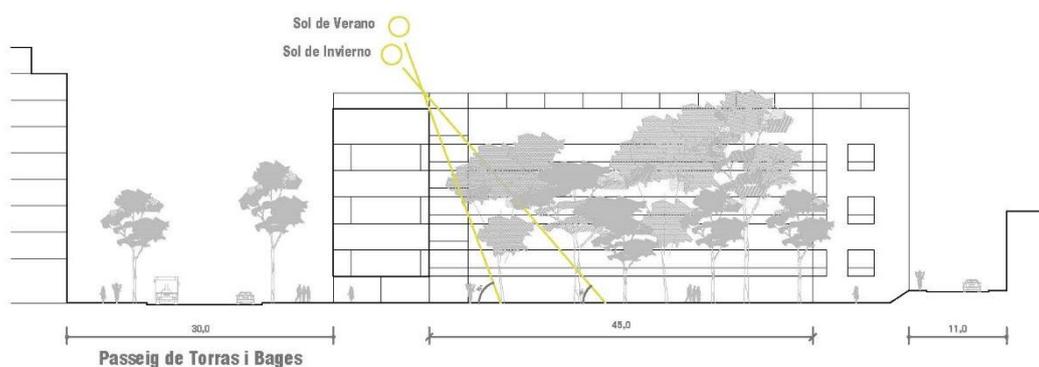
Sección transversal. Relación de la calle con las fachadas del edificio y los espacios públicos que estas configuran. Fuente elaboración propia
